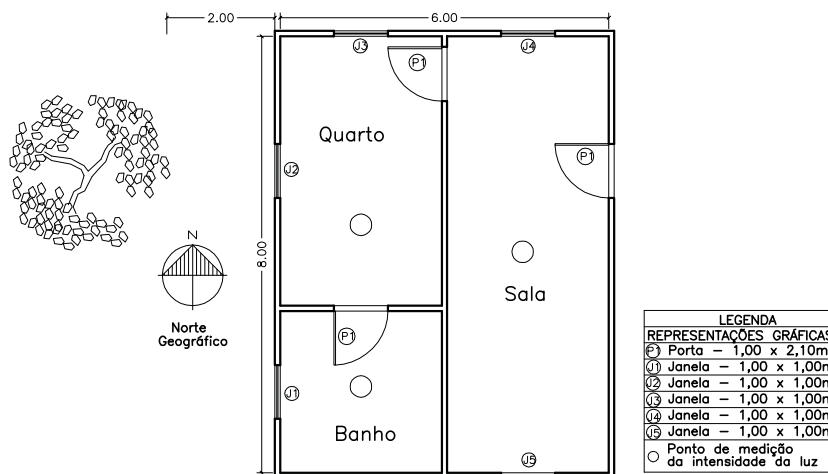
Casa Original com Árvore – Estudo de Caso 2 – Planta Baixa
